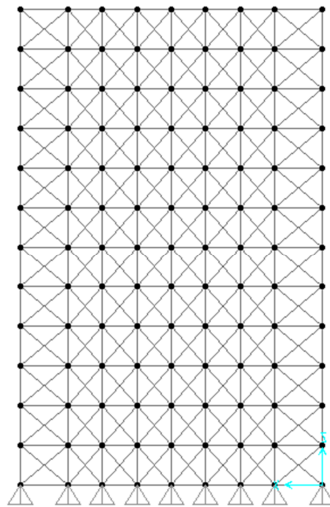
Configuração dos Planos de Contraventamento Vertical Com Elementos de Contraventamento Pequenos
